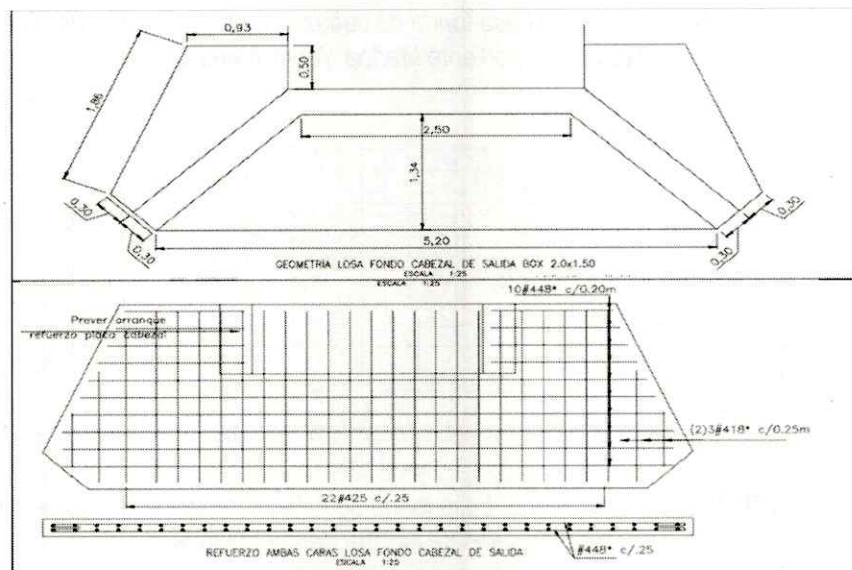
Geometría y refuerzo losa fondo de cabeza de salida Box Culvert 1.5m x 1.5m
